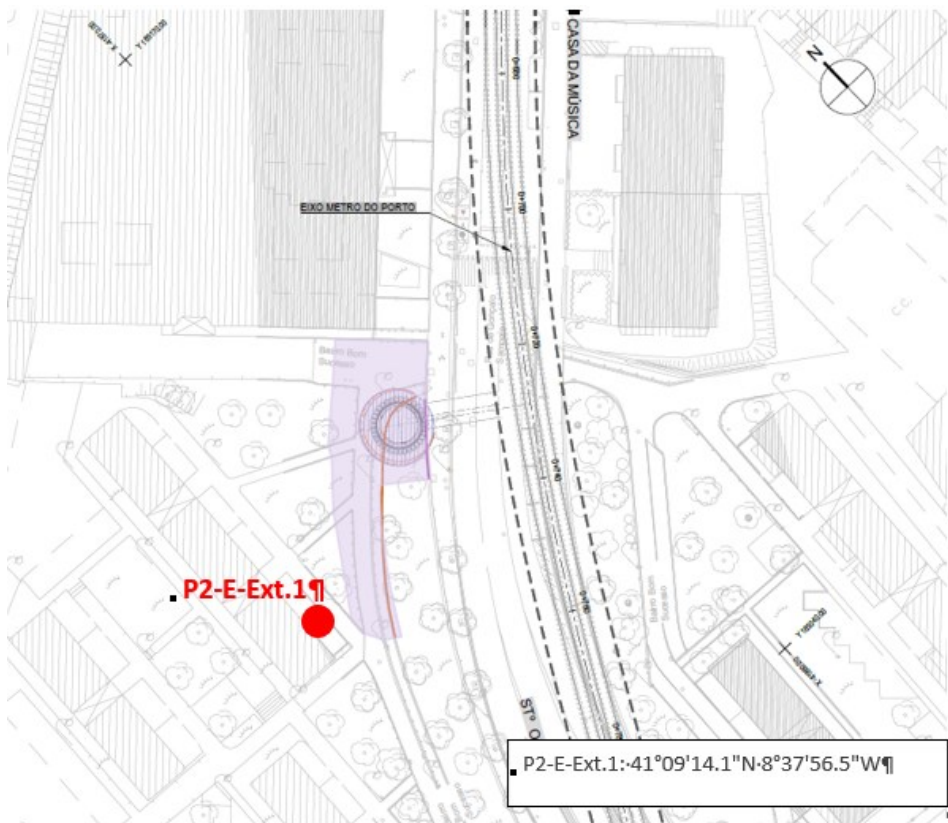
Pontos de monitorização junto aa P2-E (ruído – construção)
